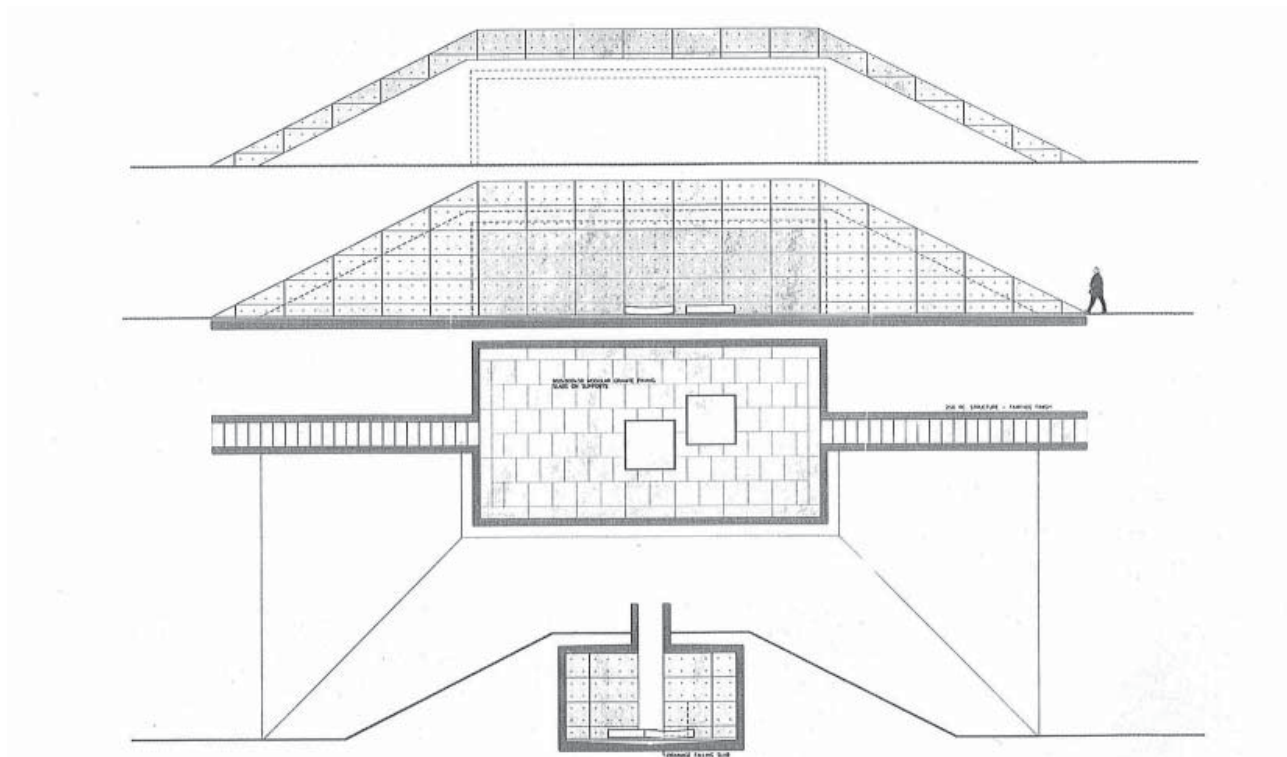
| Ansicht | Längsschnitt | Grundriss | Querschnitt
